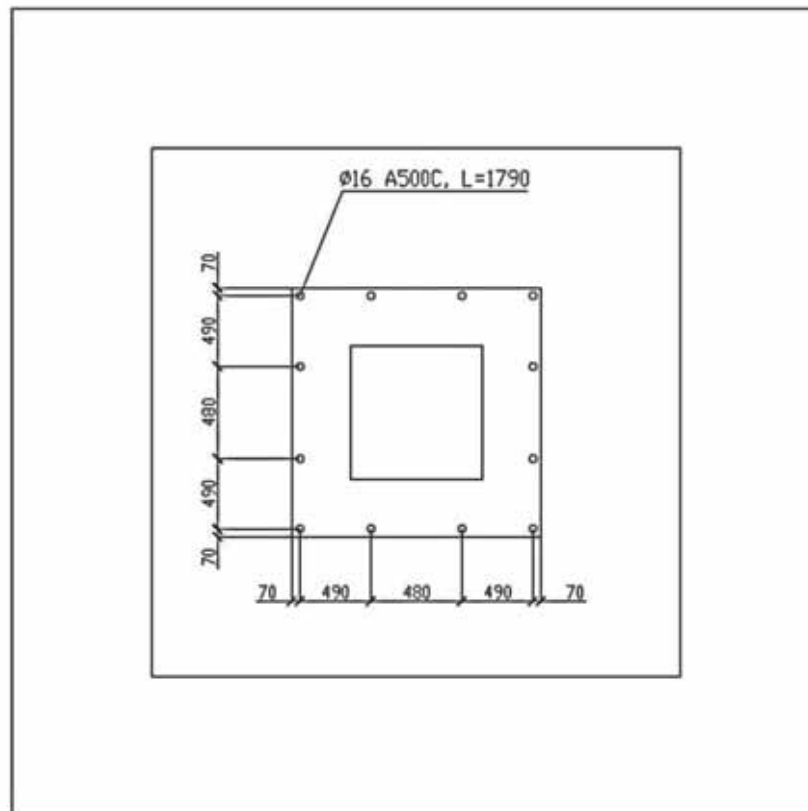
Схема расположения продольной арматуры стаканной части подколонника
